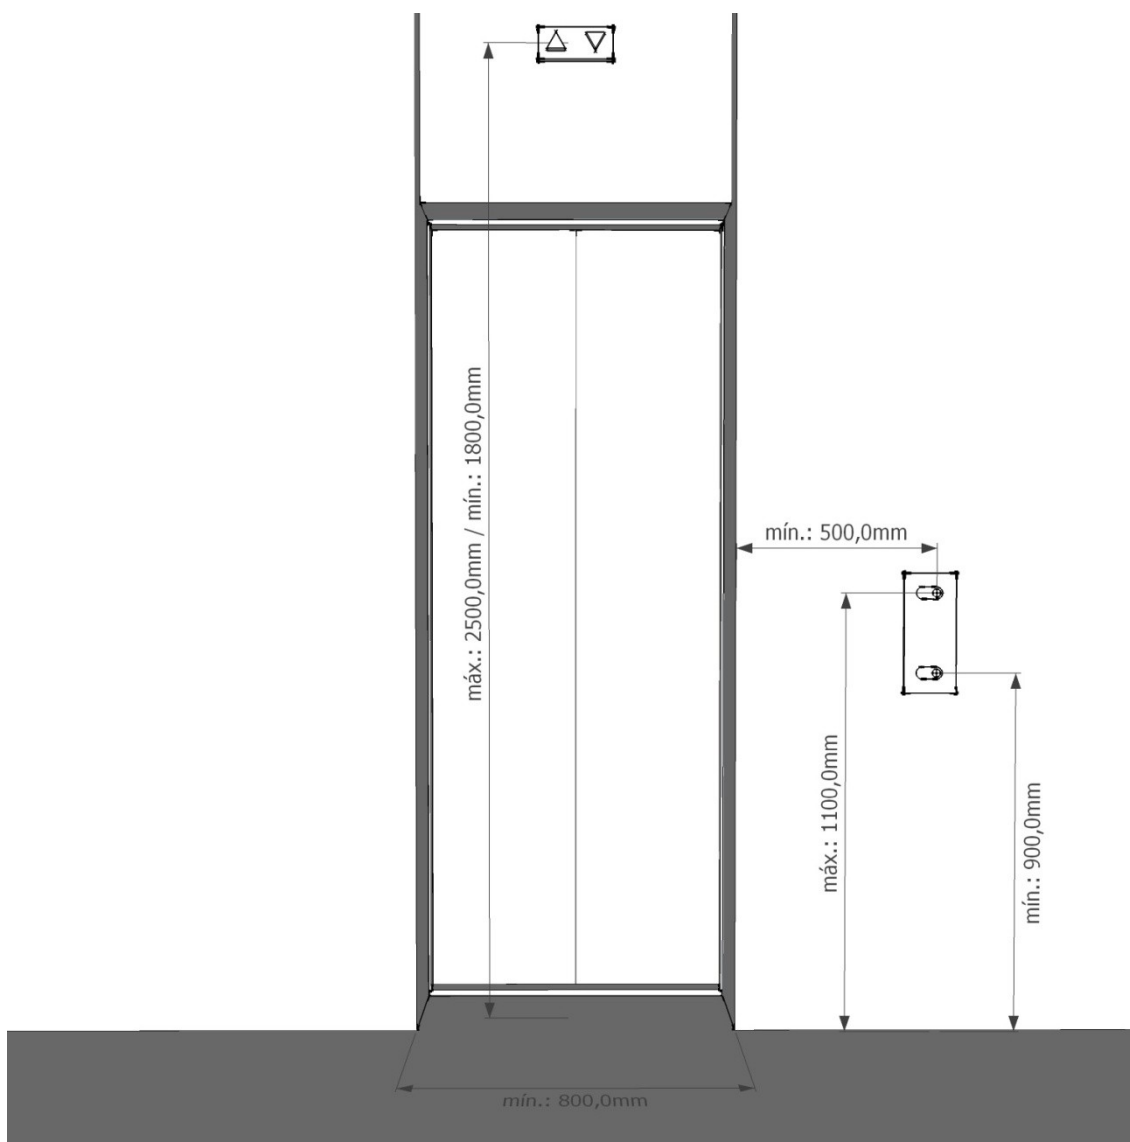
Configurações básicas de indicadores de posição e movimento, botoeiras, portas de pavimento e sinalização.
